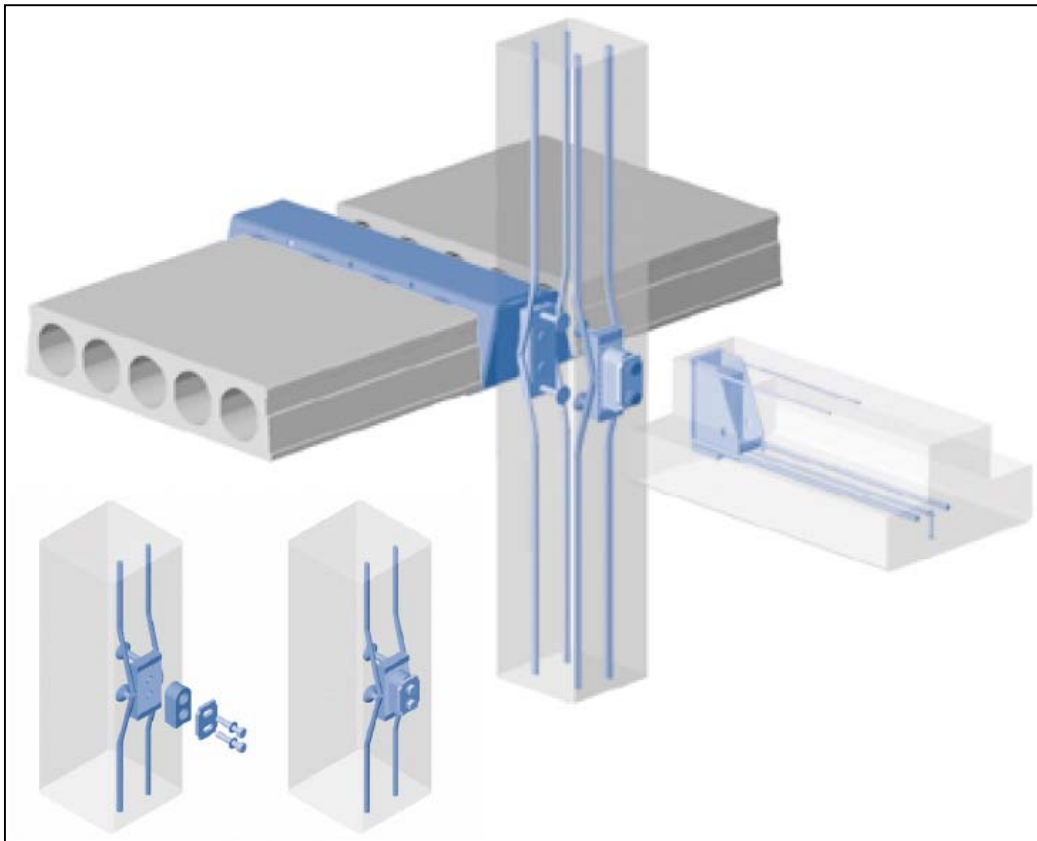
Konsolensystem zur gelenkigen Auflagerung von Stahlbeton- und Stahlunterzügen [F 4]
